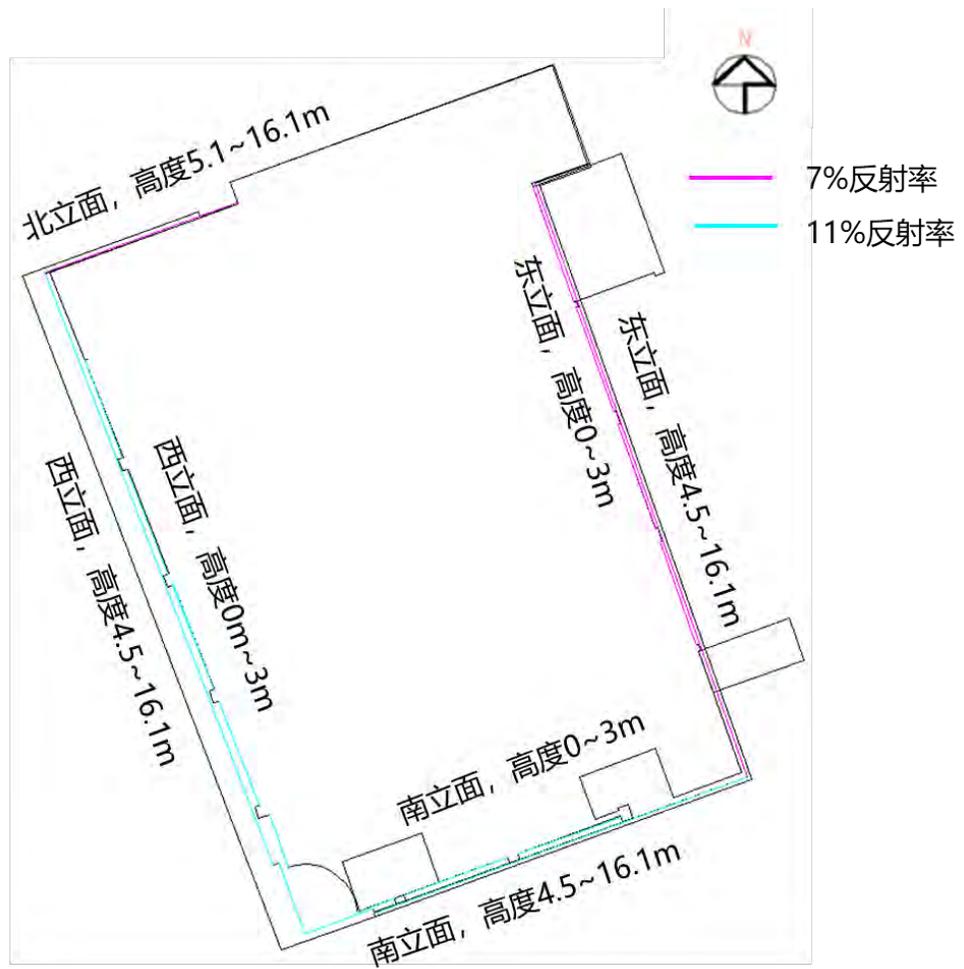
幕墙总体改造位置示意图 (平面图)
